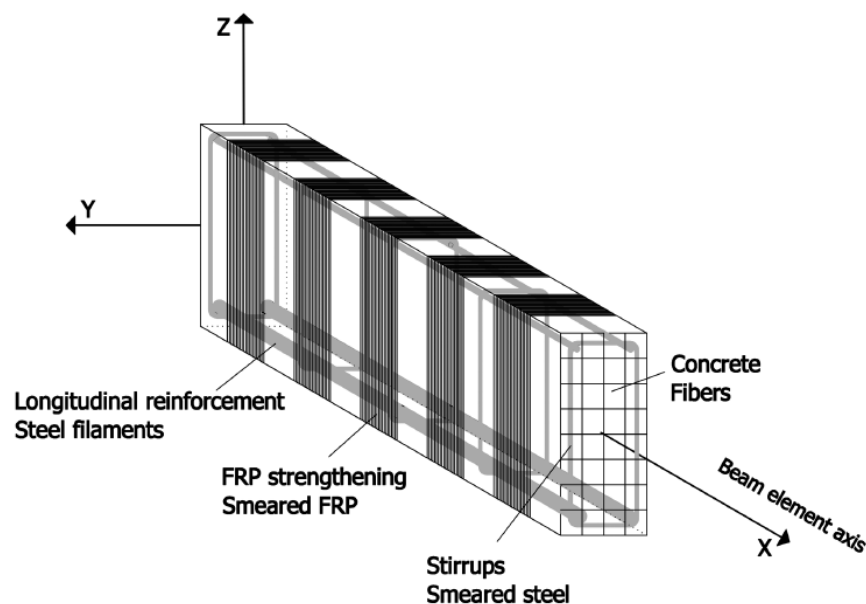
Modelo de viga de fibras de hormigón reforzado con FRP.
